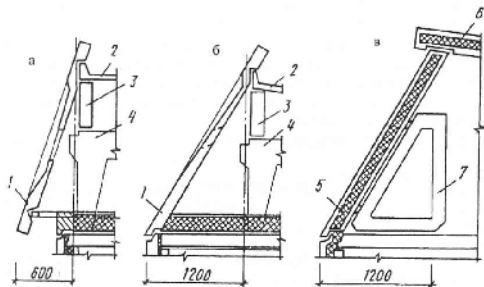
Чердачная крыша с наклонной фризовой панелью: а, б – для холодного чердака; в – для теплого чердака: 1 – холодная фризловая панель, 2 – то же, кровельная, 3 – железобетонная балка, 4 – железобетонная рама, 5 – утепленная фризловая панель, 6 – то же, кровельная, 7 – опорный элемент фризловой панели
